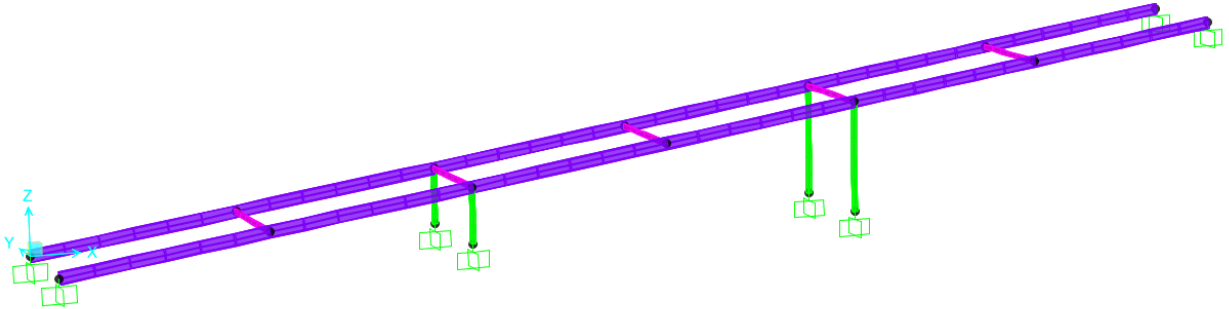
Rampa de acceso al puente. Fuente: Propia.
